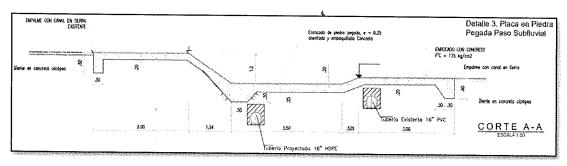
Plano HMC-122-PL-DIS-18.
